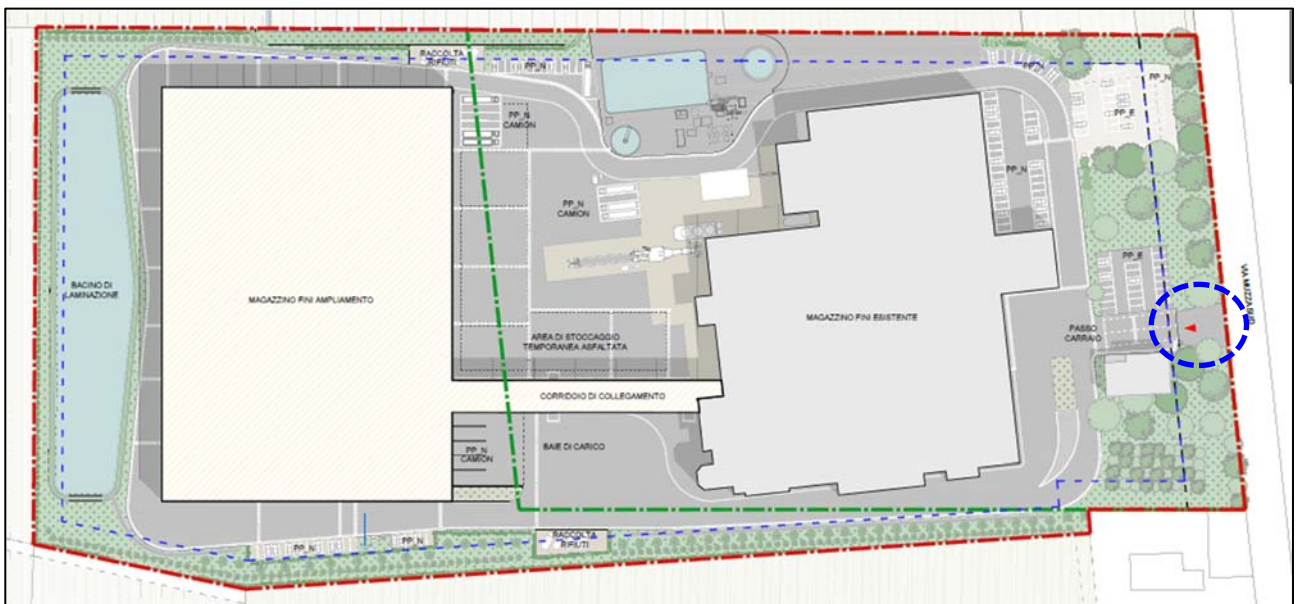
Planimetria con indicazione dell'attuale e futuro accesso allo stabilimento
